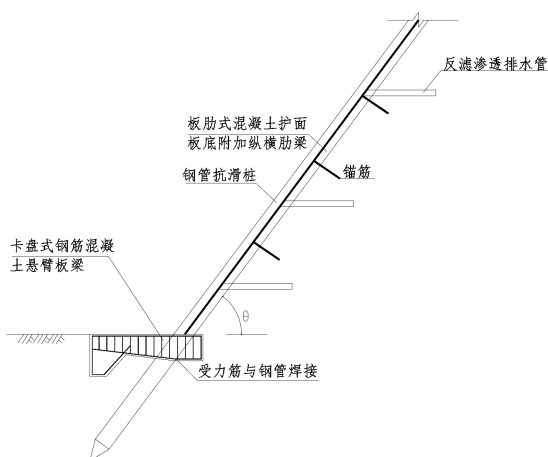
卡盘式钢筋混凝土悬臂板梁剖面图
